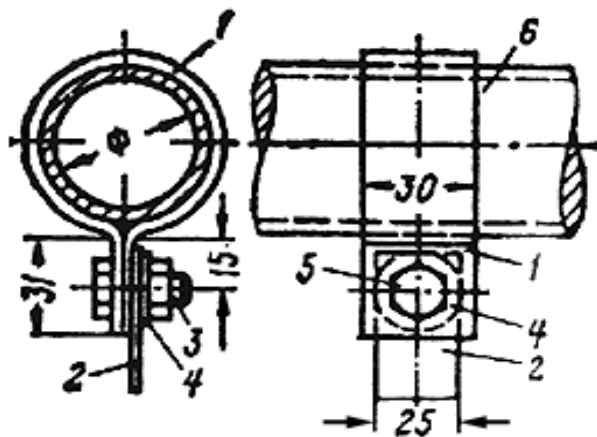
Присоединение заземляющего отвода к трубопроводу с помощью хомута:
